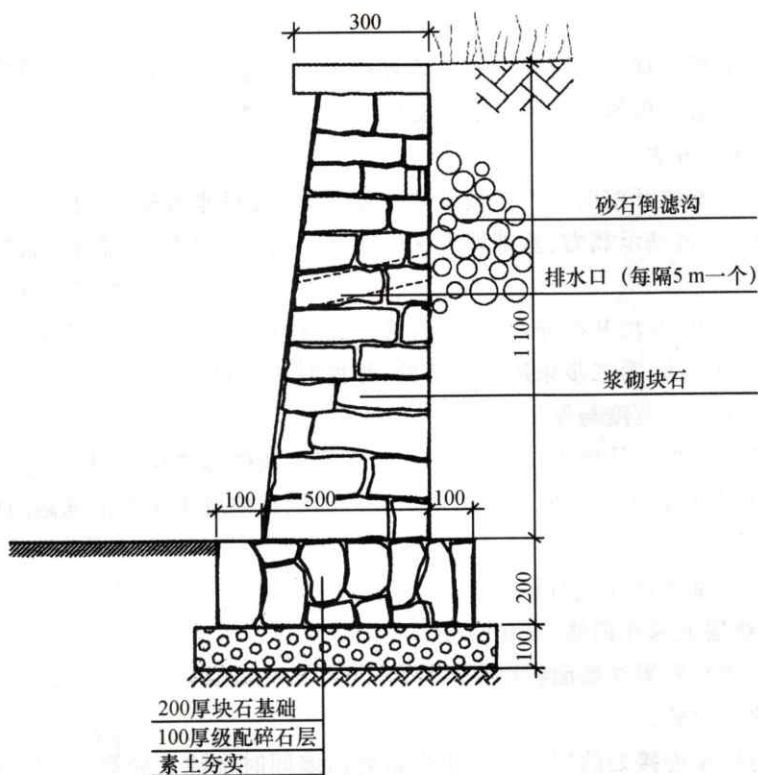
某石砌筑倾斜式挡土墙施工图(单位:mm)
